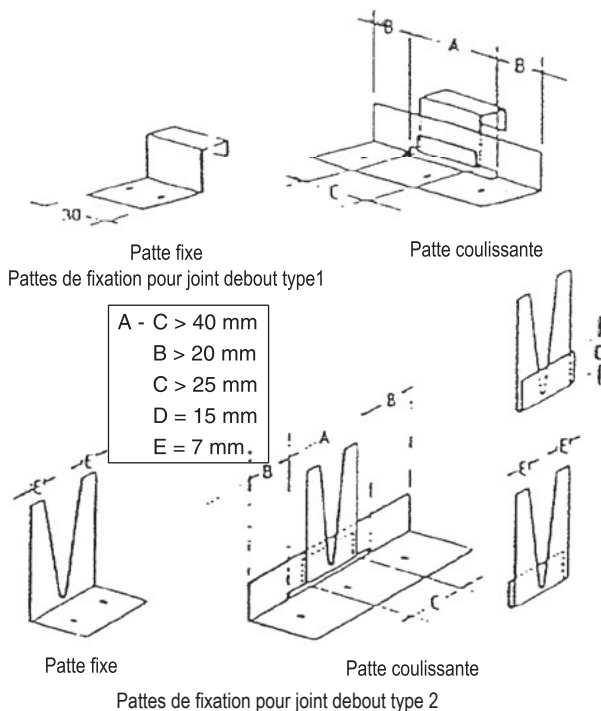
Pattes coulissantes pour couverture en acier inoxydable
